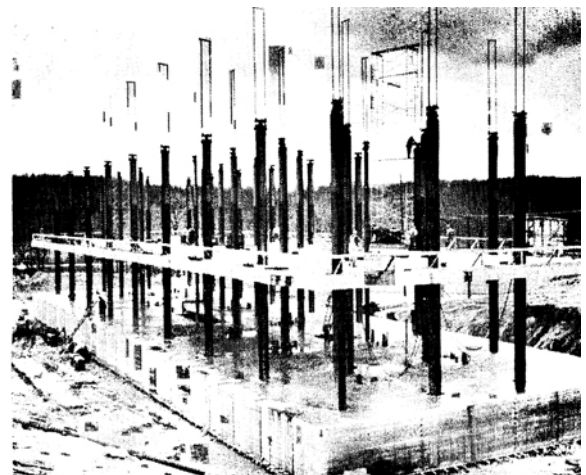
La operación del izado de las primeras dos losas juntas<sup>51</sup>
